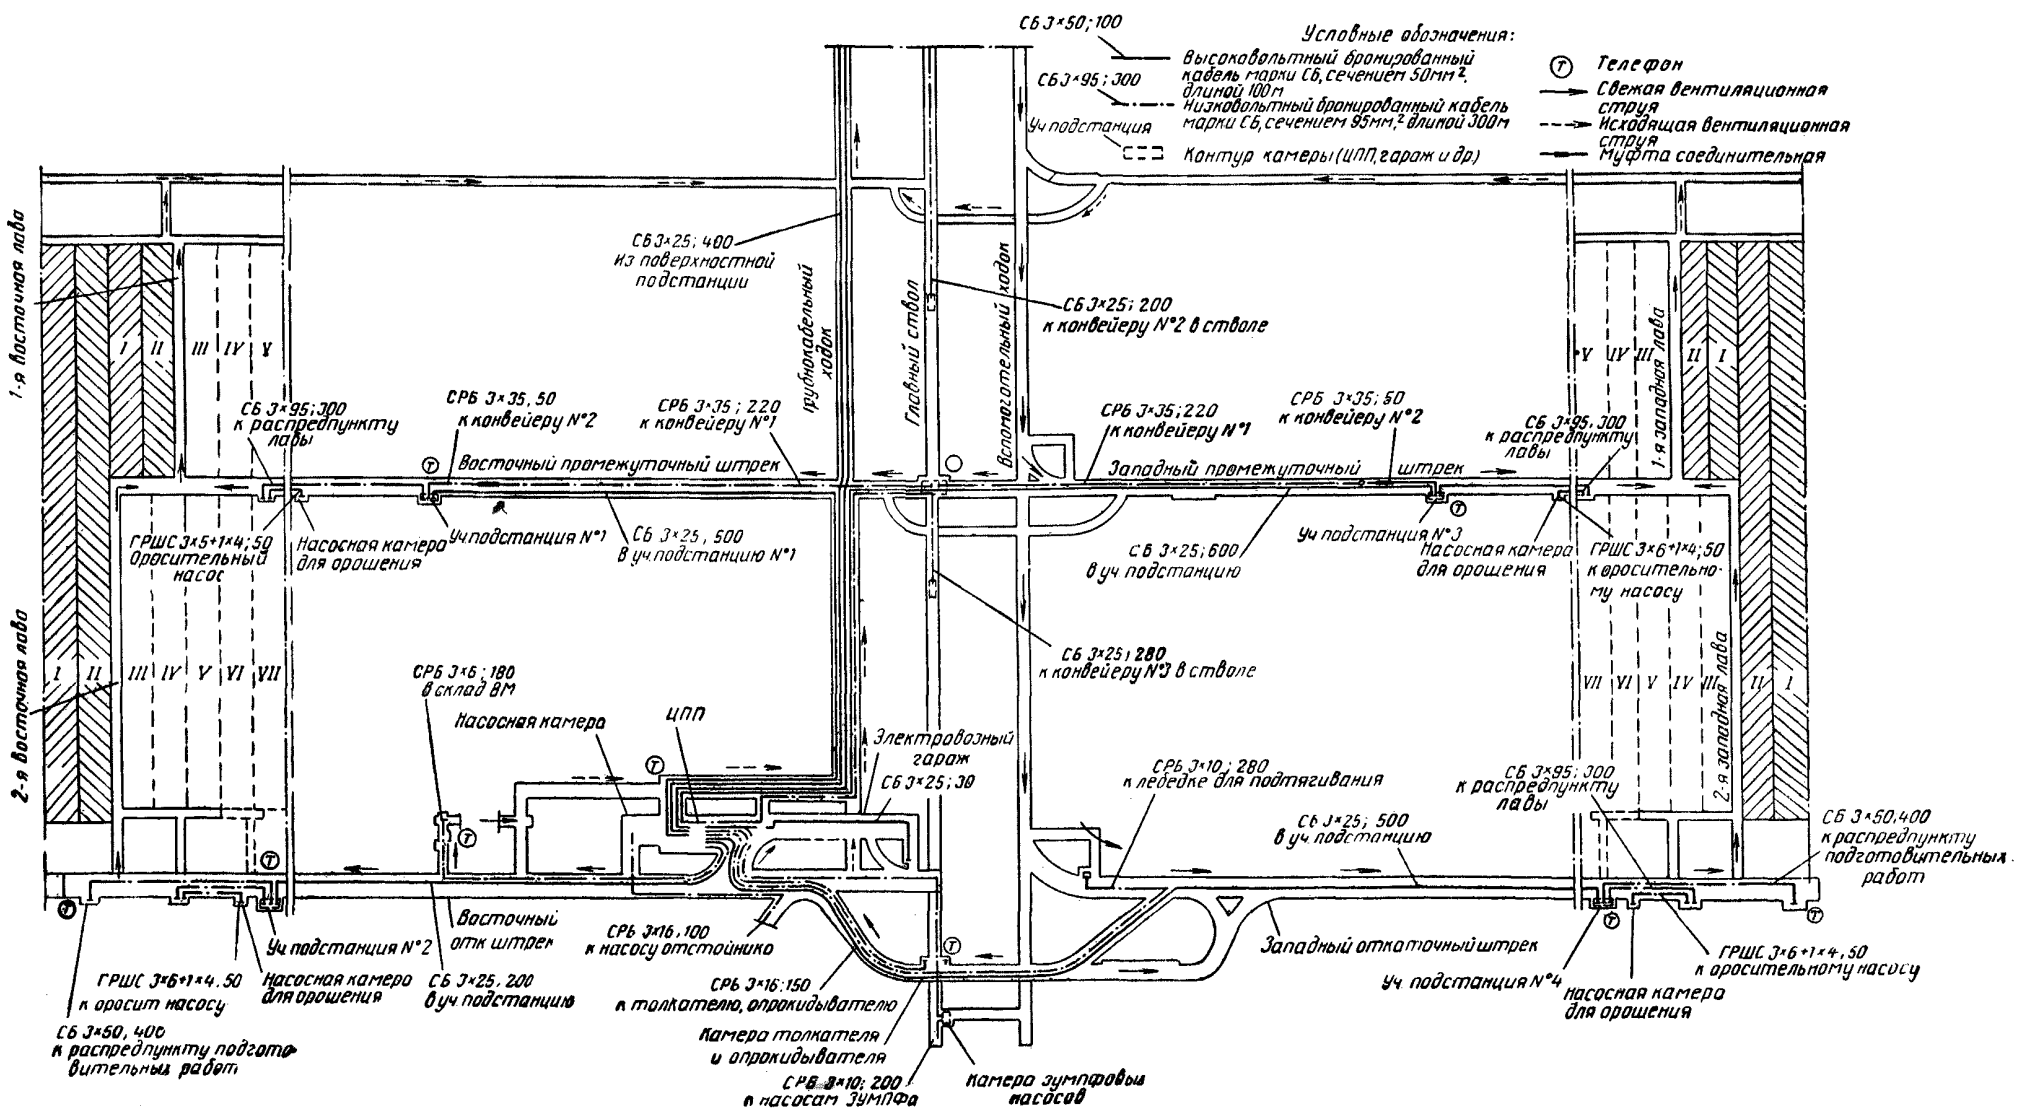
Схема подземной кабельной сети на плане горных работ пласта шахты...
